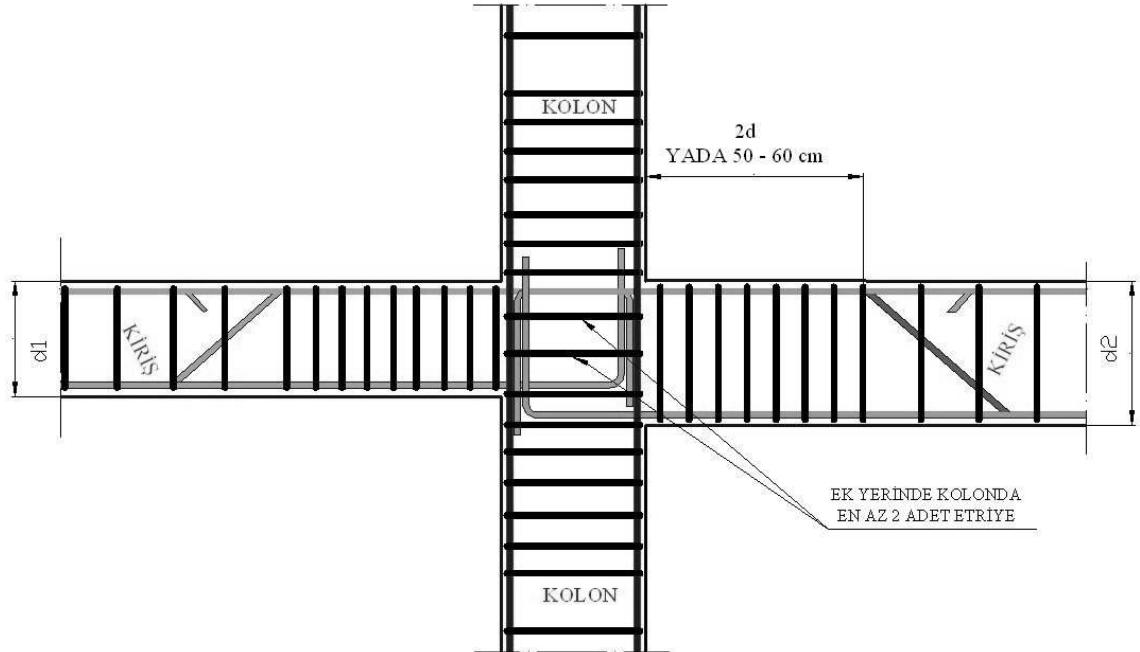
Orta aks kolonlarında kolon - kiriş birleşimi
